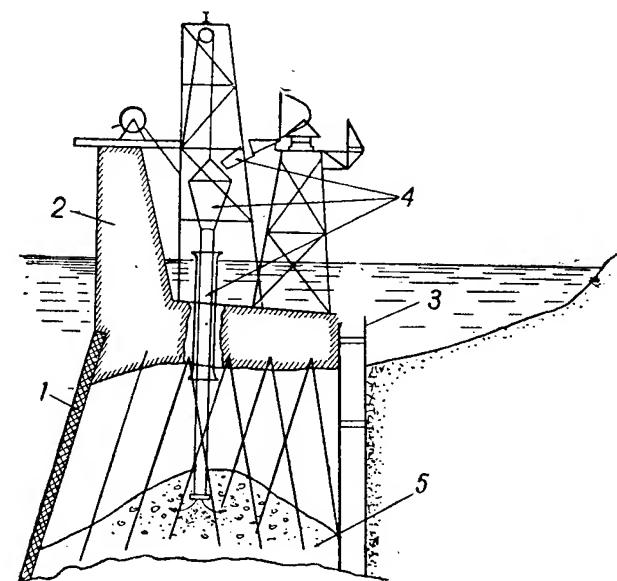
Схема восстановления причальной набережной в порту Циндао методом подводного бетонирования:
